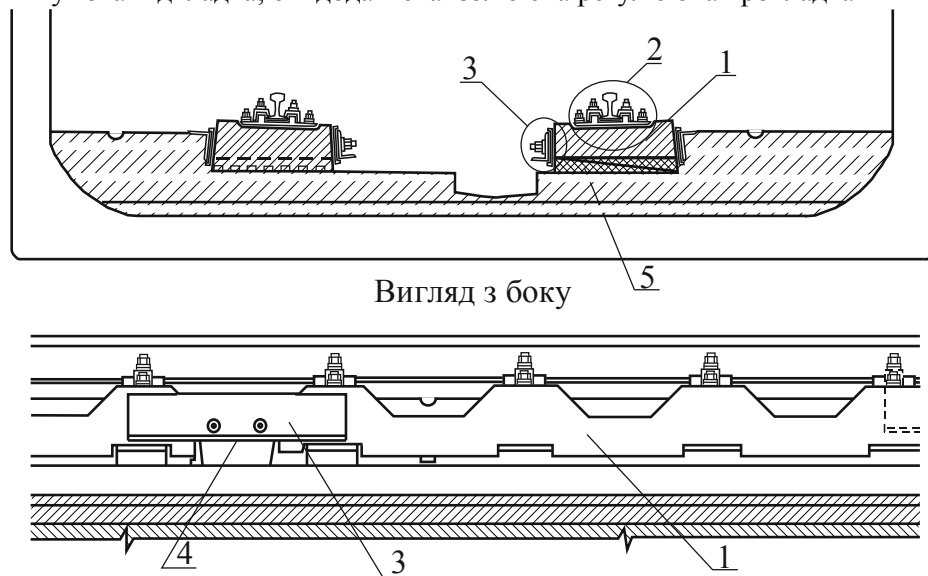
Конструкція скріплення КБ на поздовжніх лежнях: 1 – поздовжній лежень; 2 – рейкове скріплення КБ; 3 – кріплення притисного кутника до поздовжнього упору і поздовжнього упору до основи; 4 – металевий поздовжній упор; 5 – прокладка гумова регулююча
